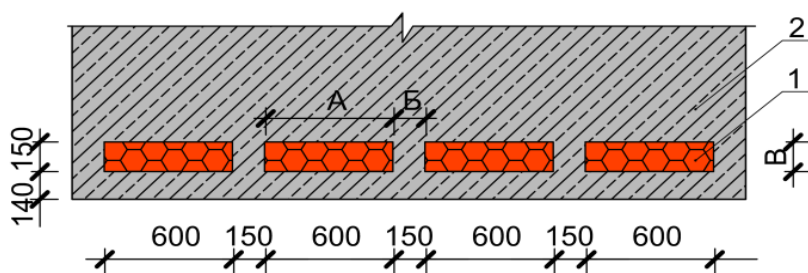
Перфорация монолитной плиты перекрытия термовкладышами: 1 – термовкладыш; 2 – монолитная железобетонная плита перекрытия
